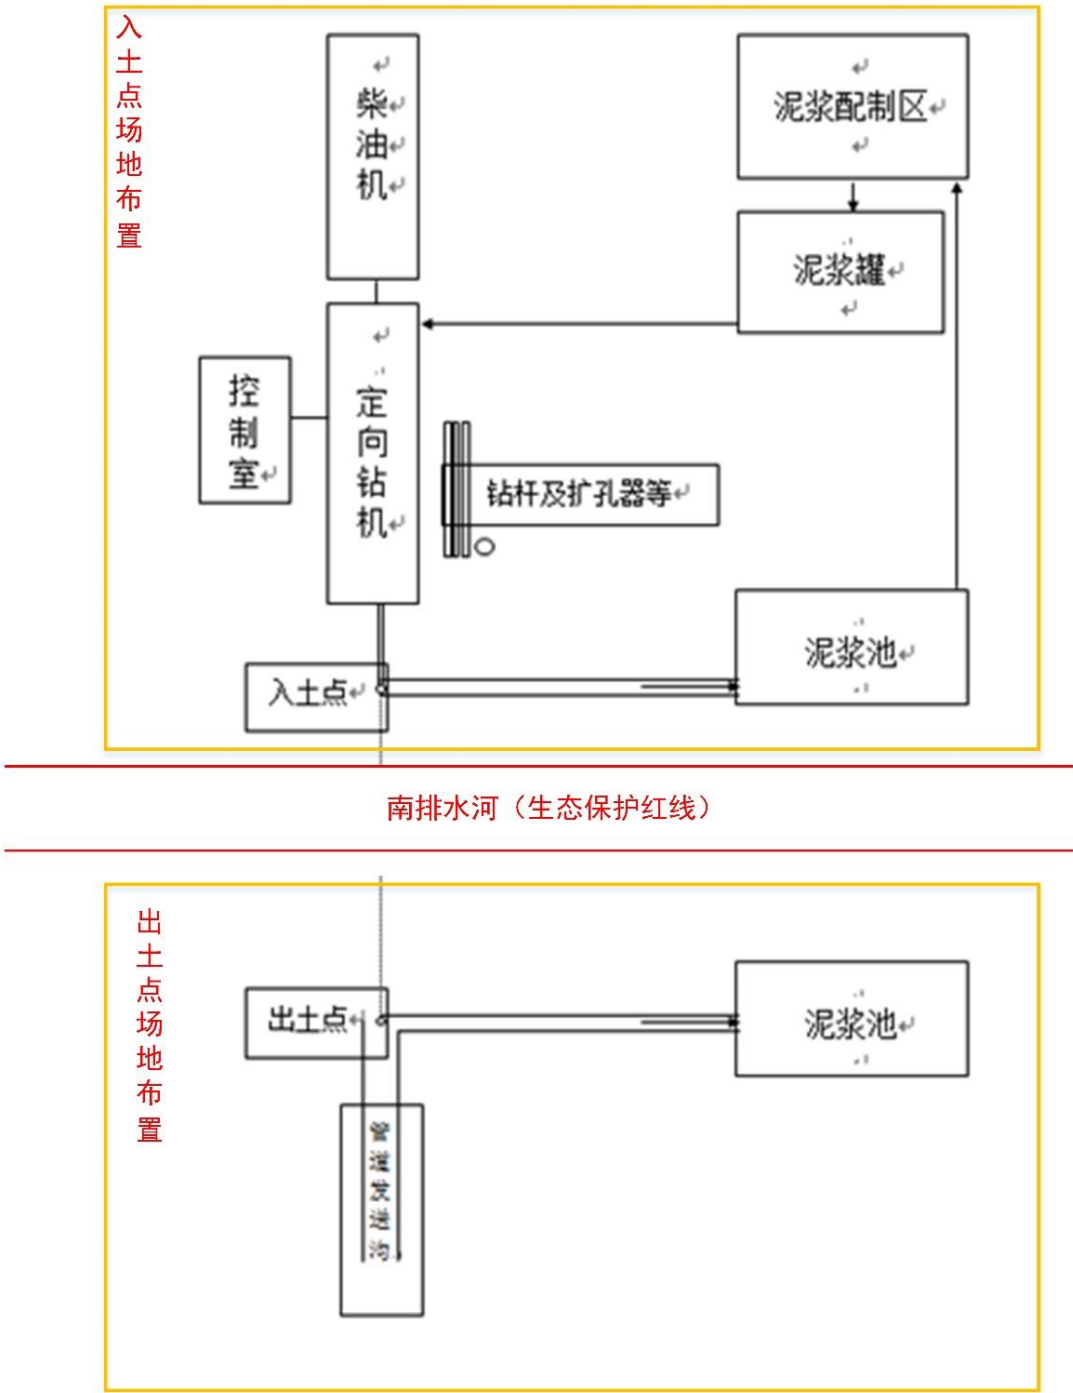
南排水河生态保护红线施工场地布置示意图
